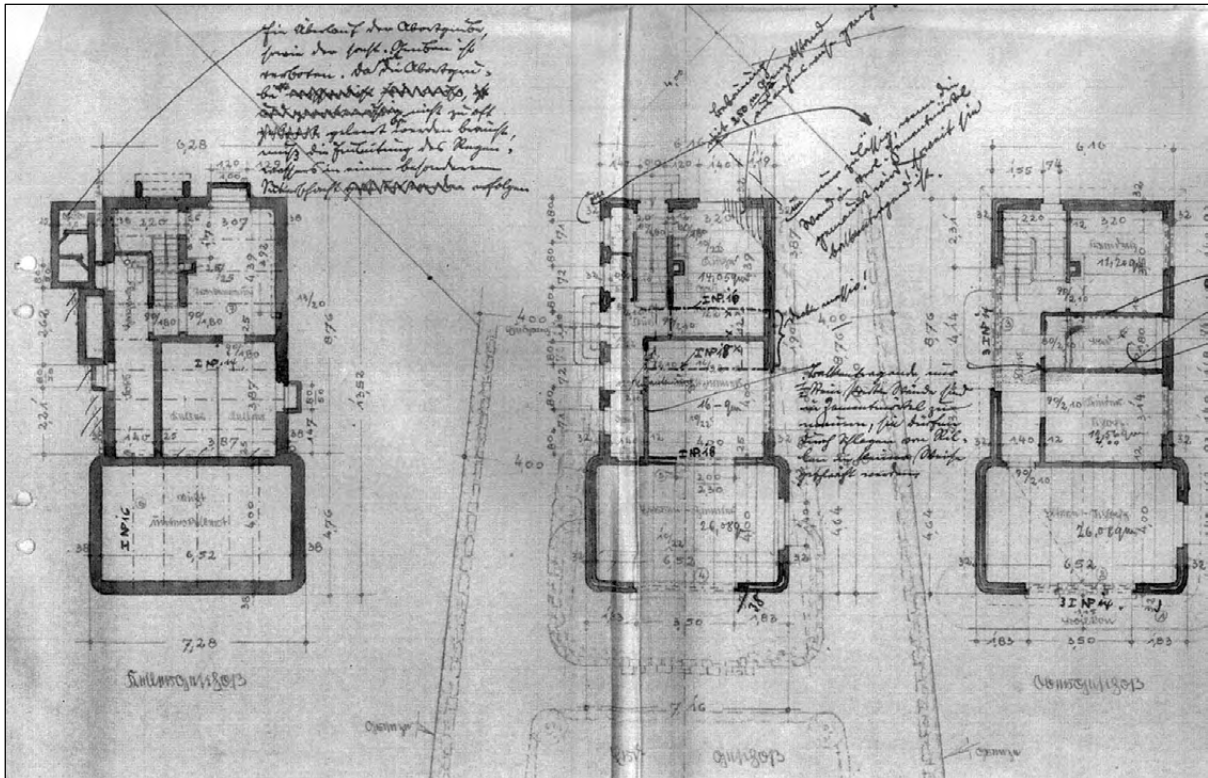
Abb. XXVI Gütersloh, Dalkestraße 9, Grundrisse Haus Westerbarkey
